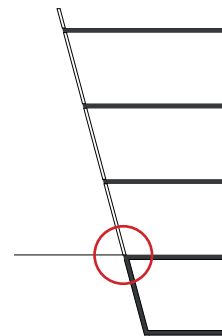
Fassadenschnitt 3D - Geländeranschluss
